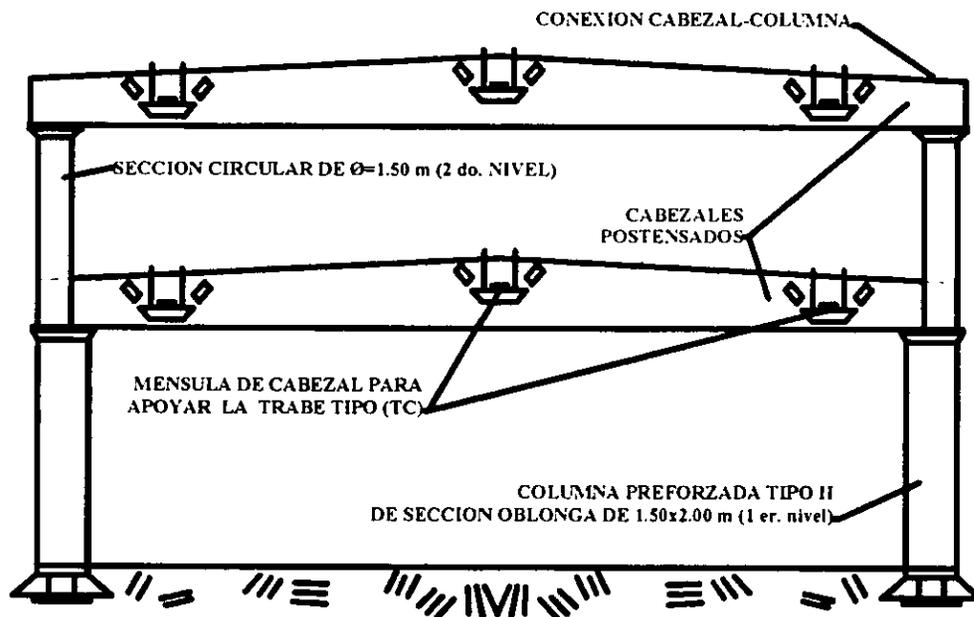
Corte transversal 2Do. Nivel con columnas tipo II
